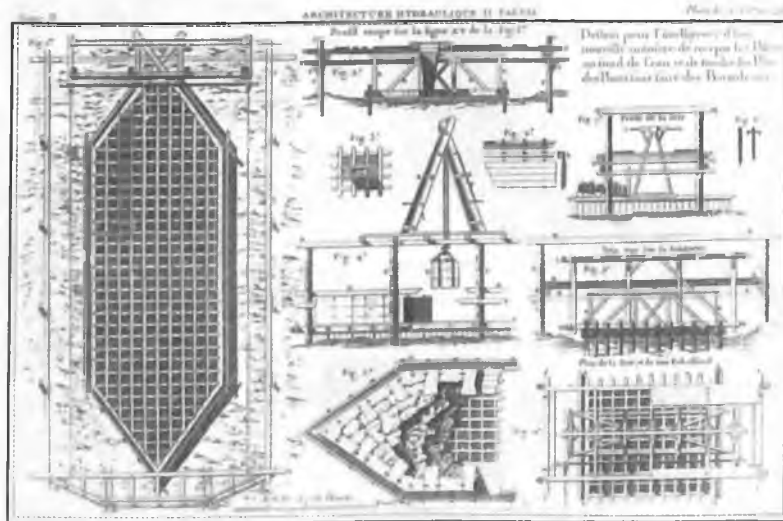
Cimentación de puentes en el fondo del cauce de un río.
